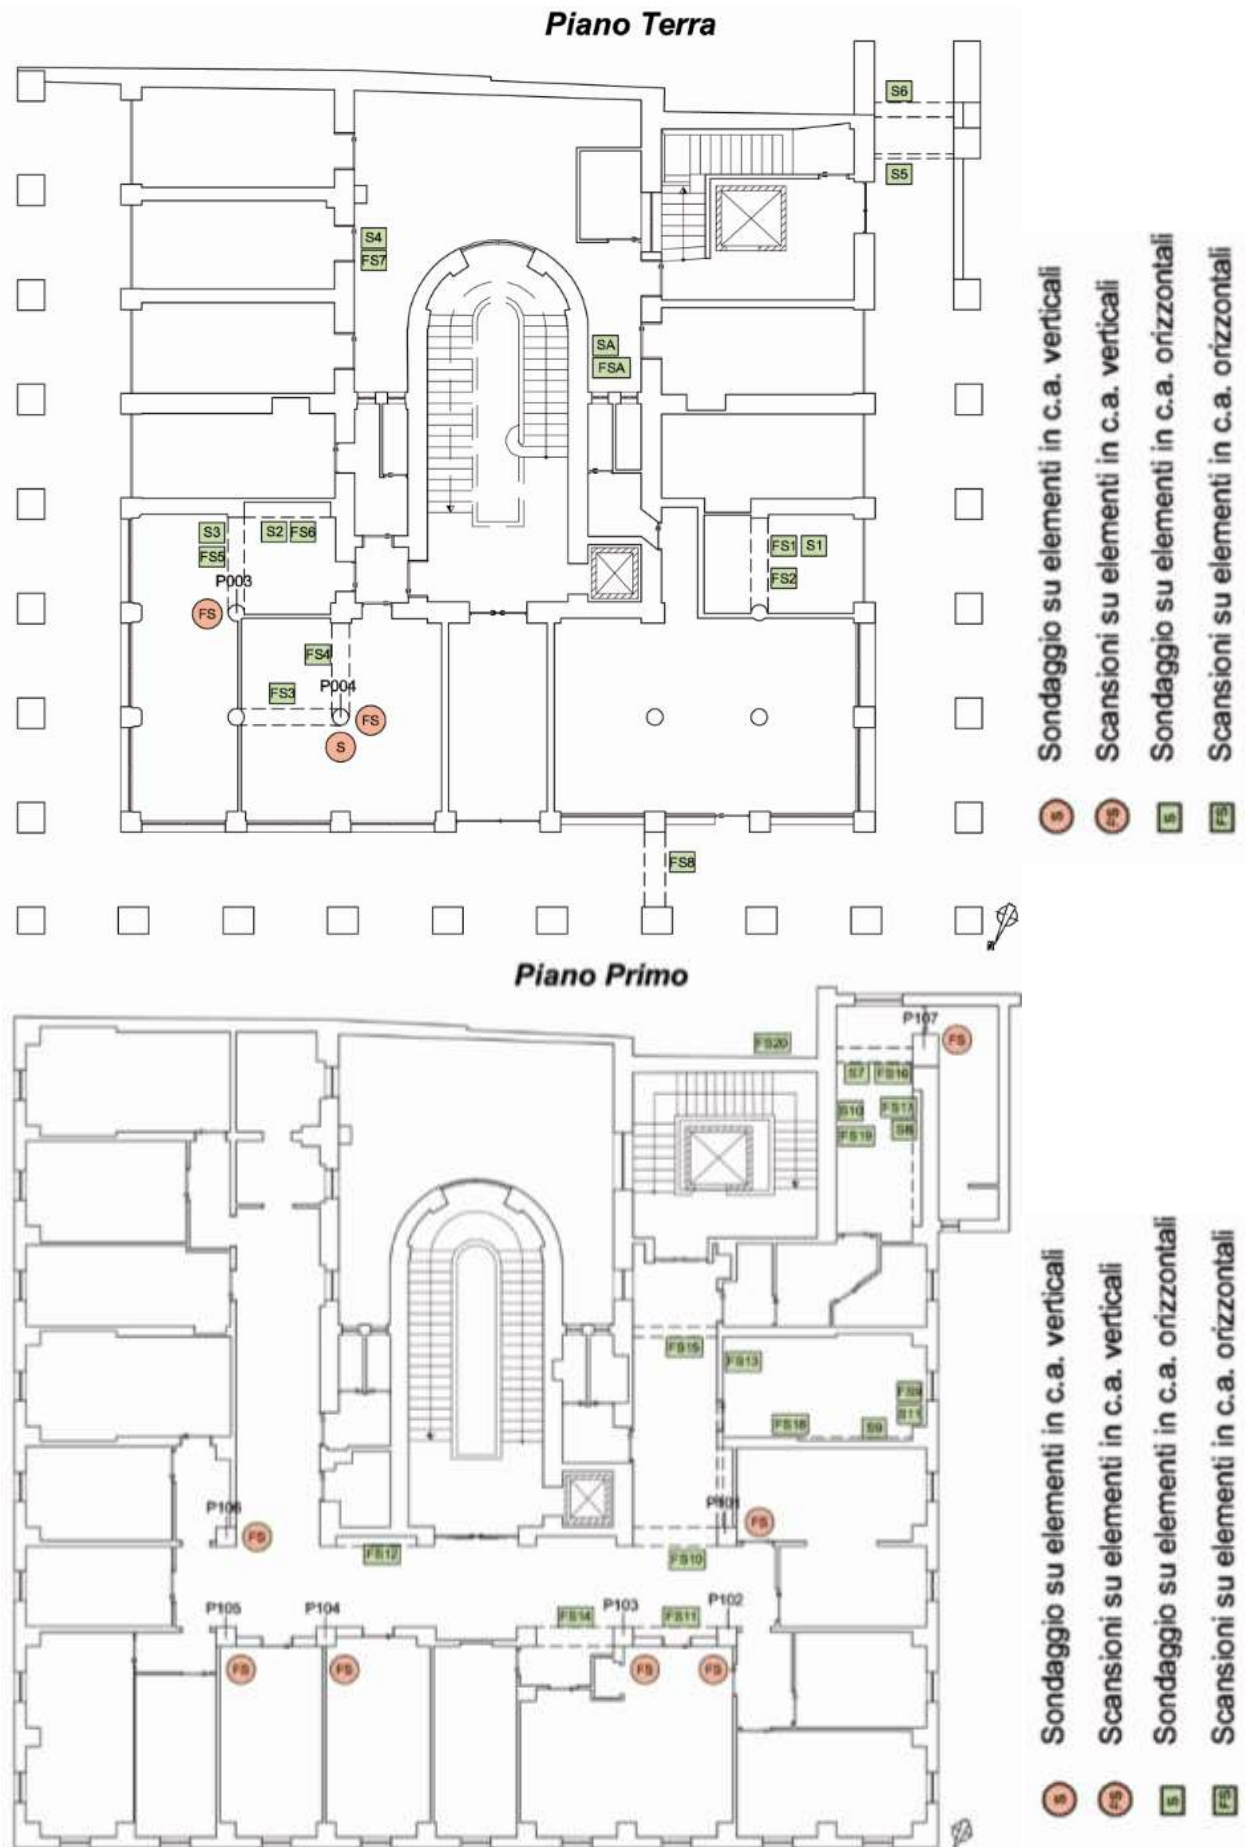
Pianta chiave con indicazione dei punti di sondaggio sugli elementi in c.a. ai piani terra e primo.
